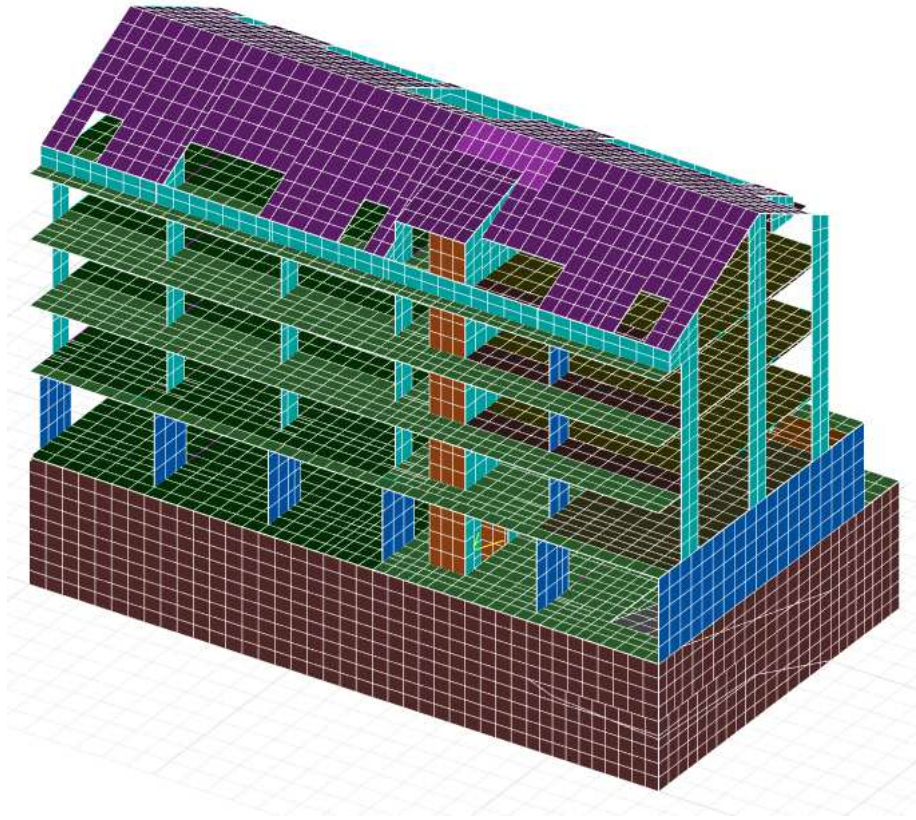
Vista 3D do Modelo de Cálculo (1/2)
